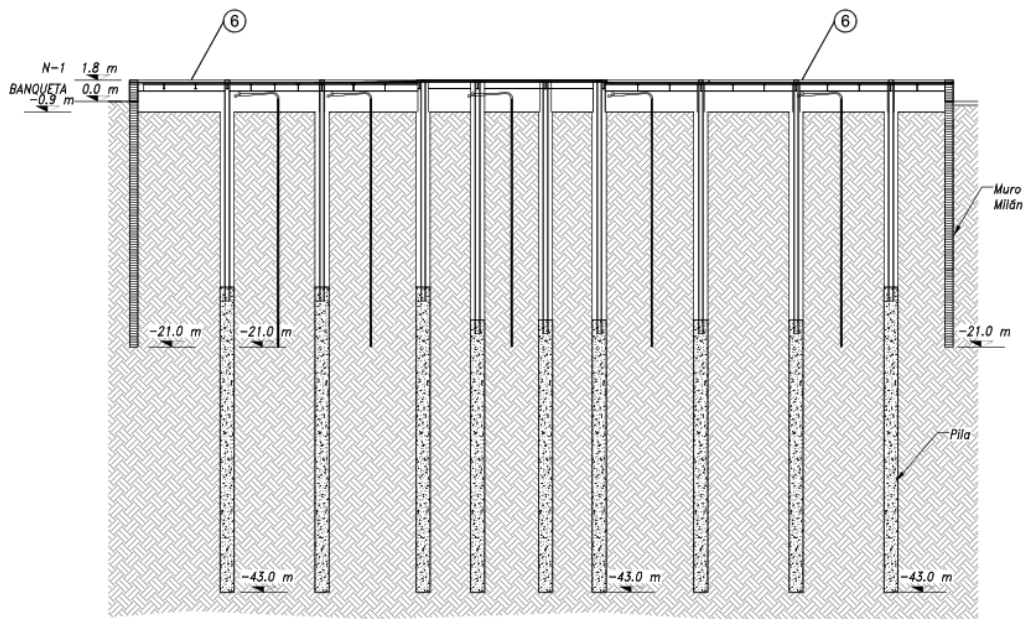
Proceso constructivo Top-Down – Etapa 6. Fuente: Cortesía del proyecto Marina 385
